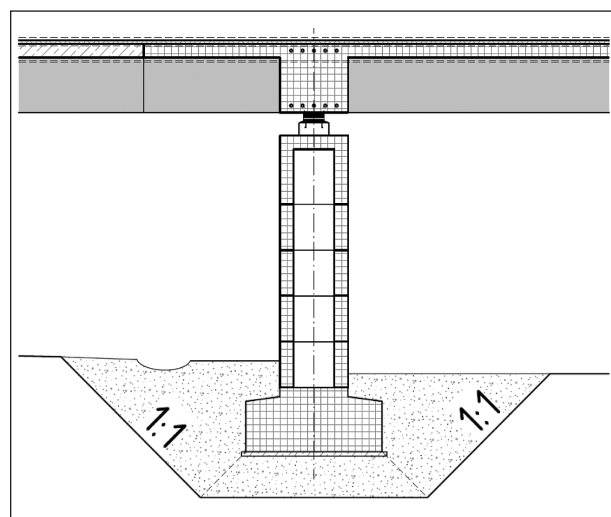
Schnitt Stahlbetonhohlquerschnitt
